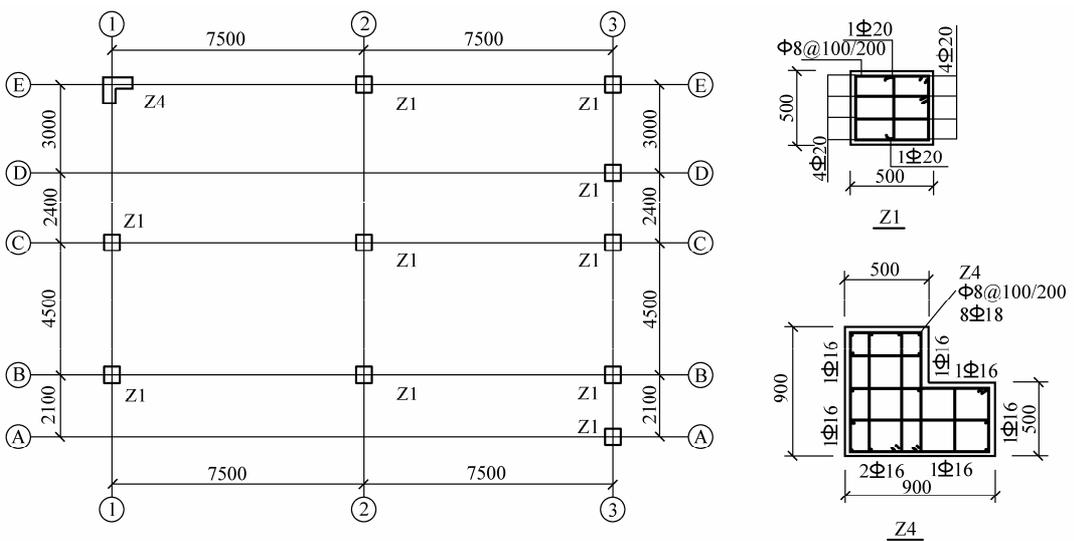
地下室柱配筋平面图 (基础顶-4.150)
